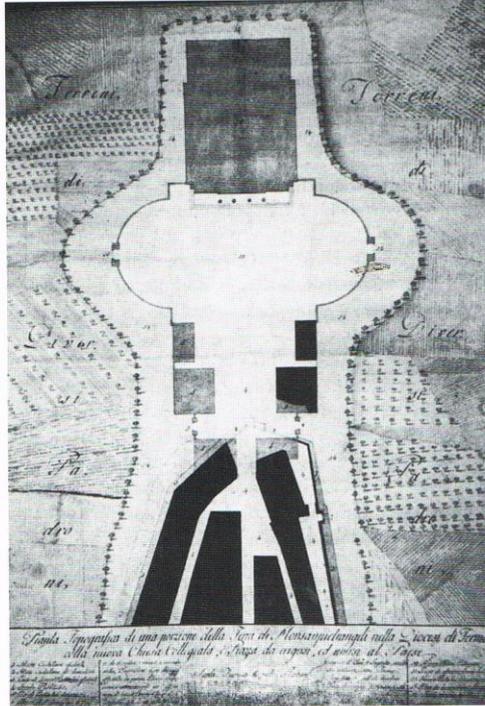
Planimetria della collegiata di Montespiertrangeli nelle Marche.
